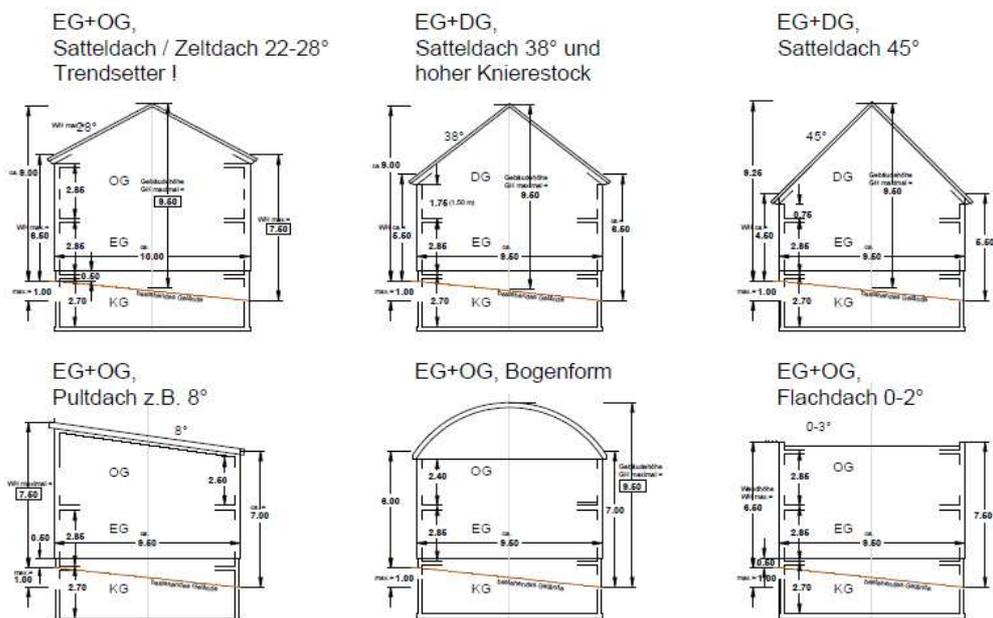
Gebäudetypen II Vollgeschosse Schnitte
